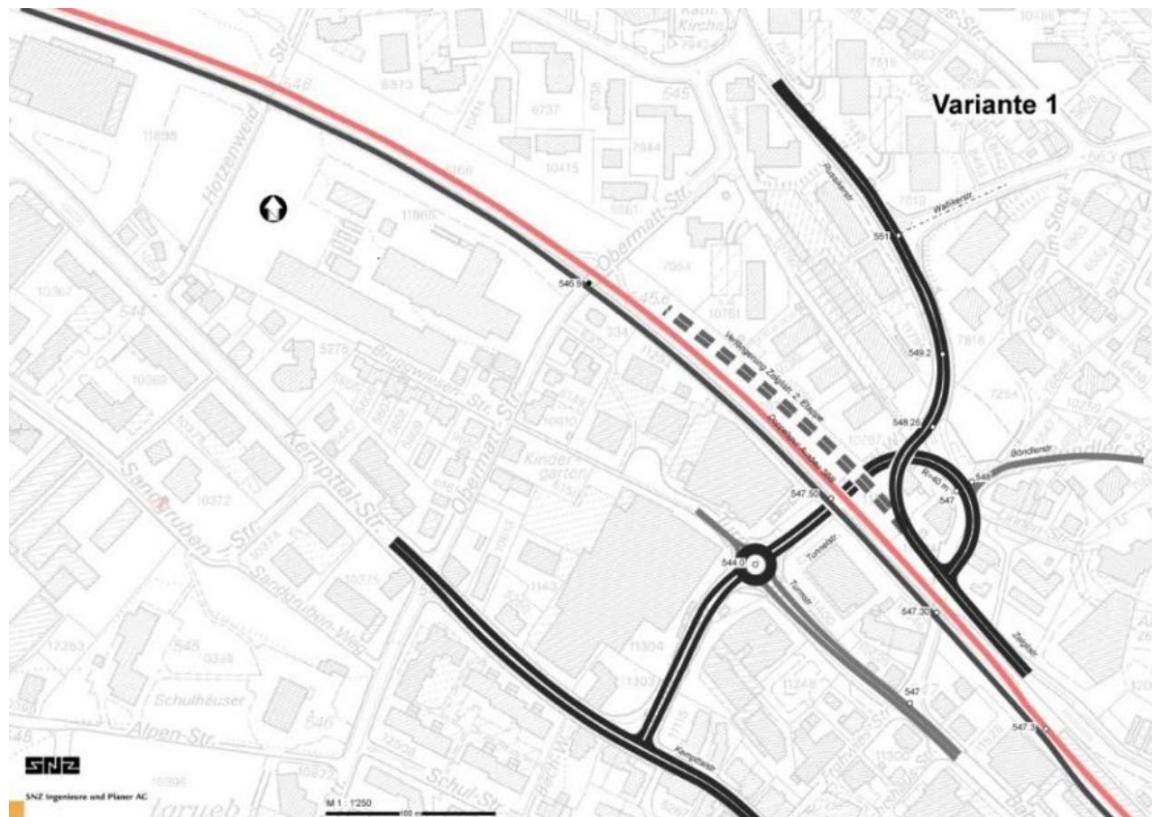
Schema Unterführung Tunnelstrasse, Variante 1 gemäss Bericht SNZ 2023
